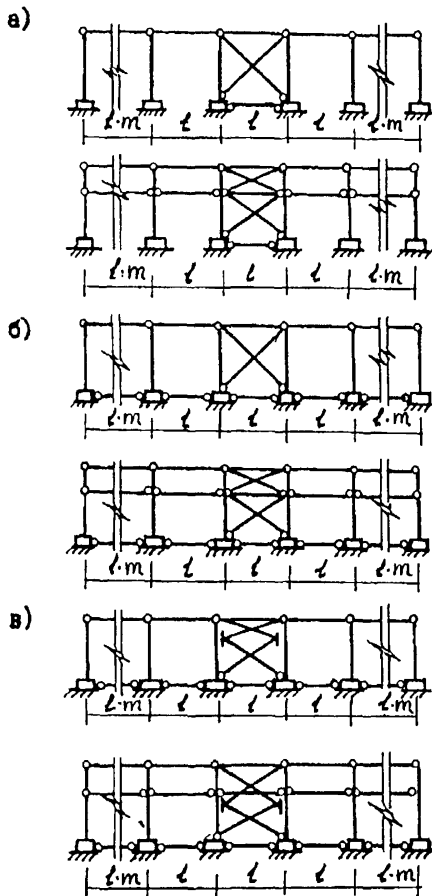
Схемы продольных рам одноэтажных каркасных зданий (бескрановых и с мостовыми кранами)
